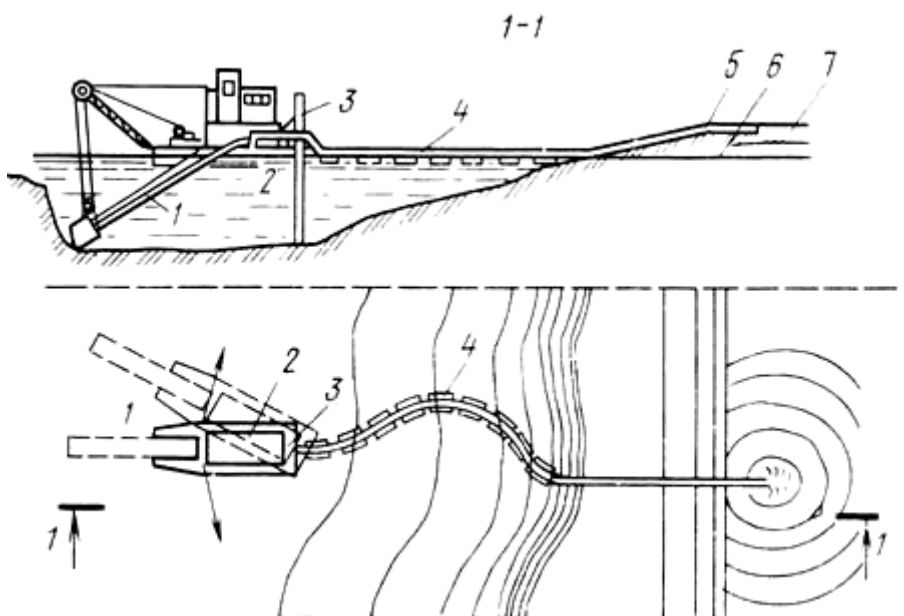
Землесный способ разработки грунта: 1 - всасывающее устройство; 2 - судно с насосной установкой; 3 - опорная свая; 4 - плавучий пульповод; 5 - береговой пульповод; 6 - обвалование; 7 - намываемое земляное сооружение.
